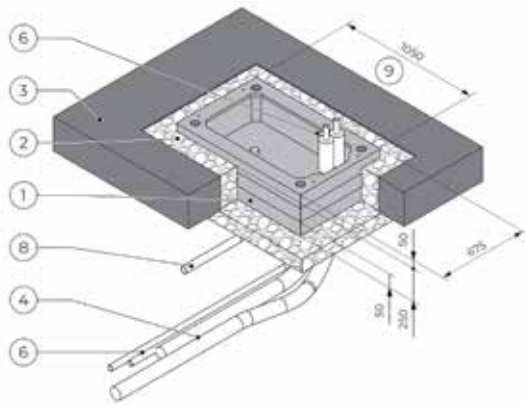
Betonsockel auf Unterlagsbeton [mm]
